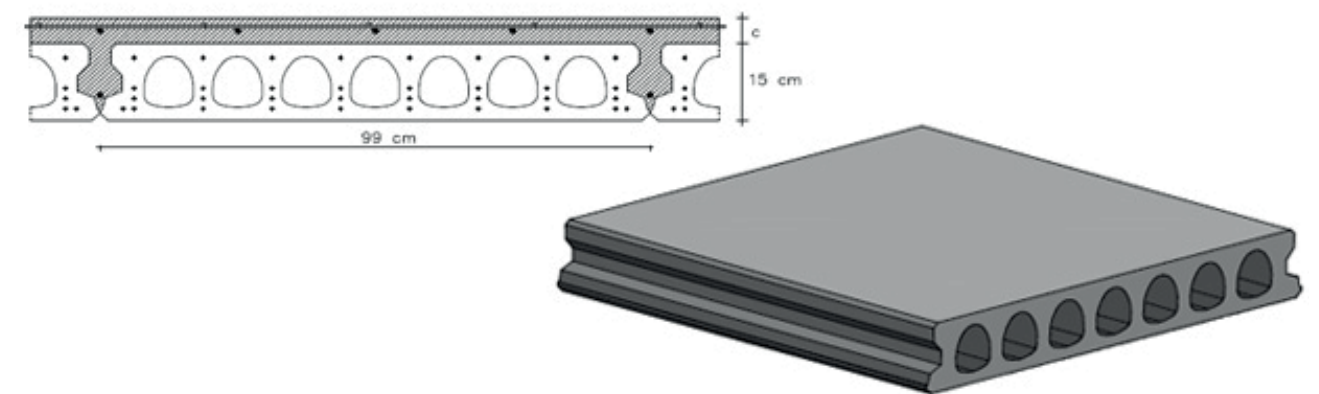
Losa alveolar y su montaje en obra. Fuente:
